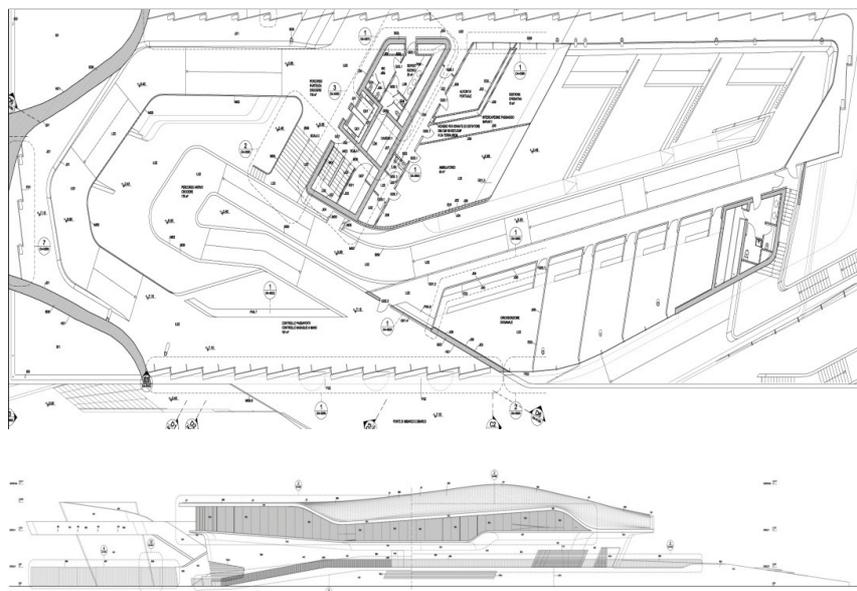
Stazione marittima di Salerno: pianta e prospetti del terminal
